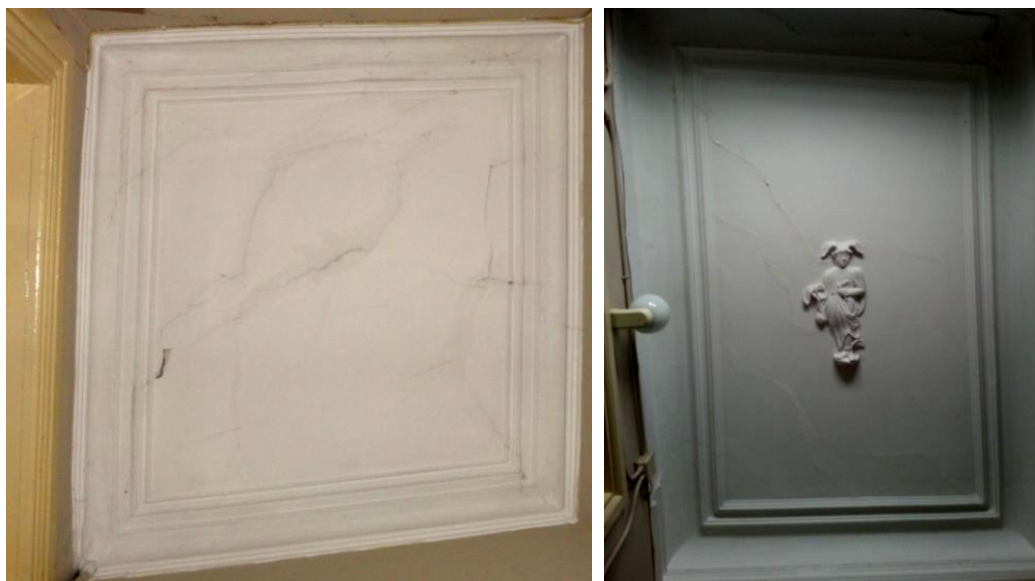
Fissuração visível nos tetos estucados correspondente ao patamar de escadas que liga o 1ºAndar às águas furtadas (esquerda) e no teto do R/C (direita).
